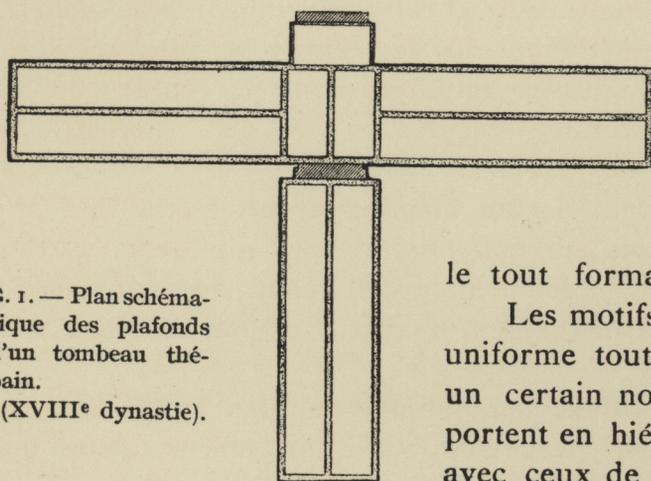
Plan schématique des plafonds d'un tombeau thébain. (XVIII^e dynastie).
